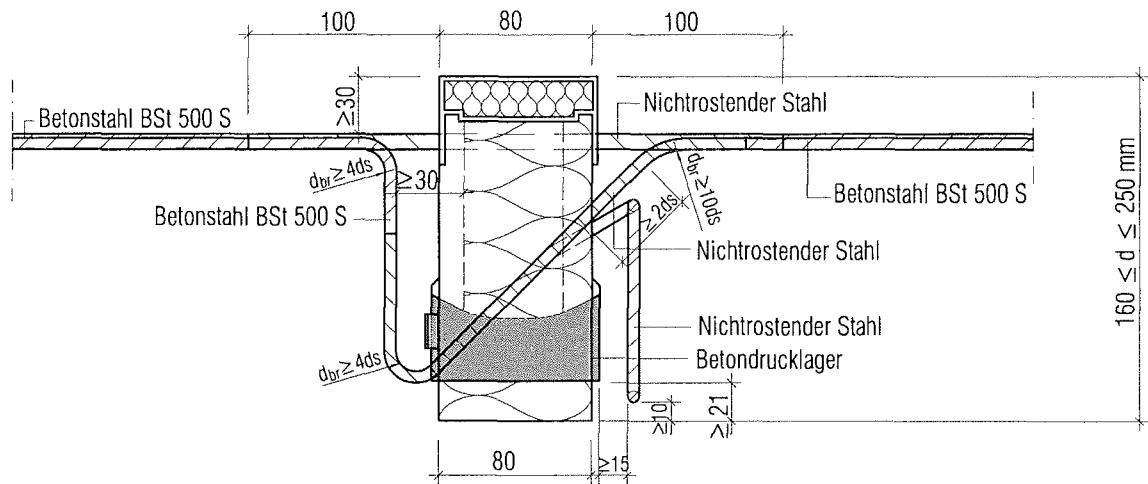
Schöck Isokorb Typ K¹⁾ mit Druck- Querkraft Kombination, integrierter Aufhängebewehrung und Drucklageraufhängung
